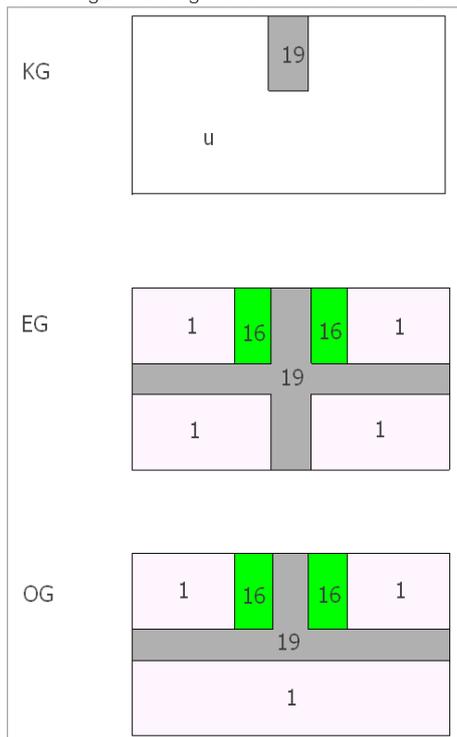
Bürogebäude: Grundrisse mit Zonierung
